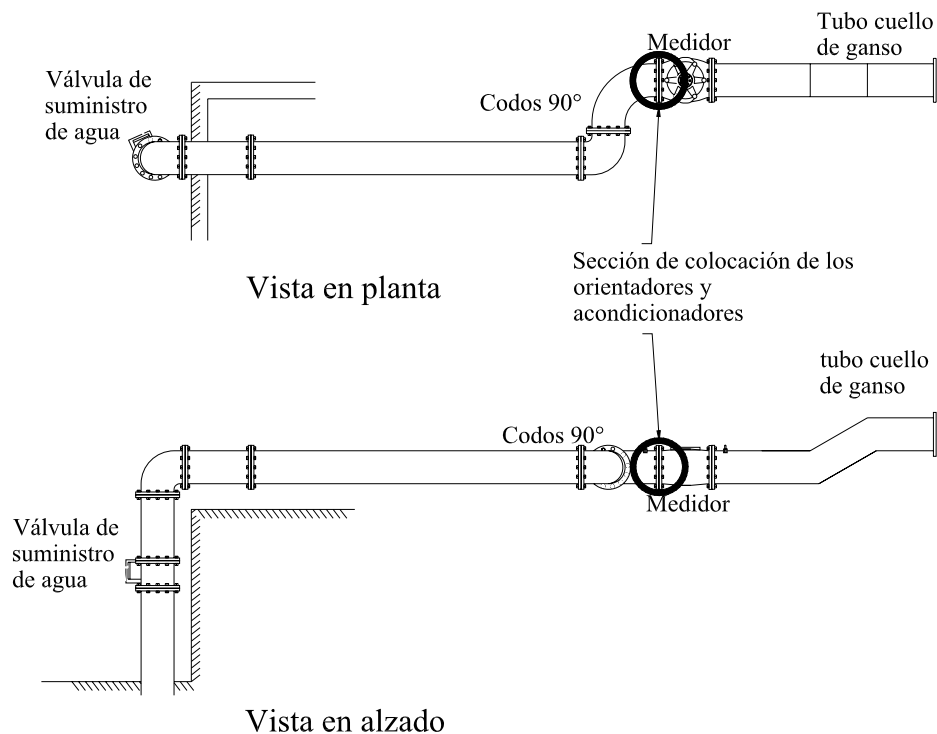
Esquema del tren de descarga; detalle planta y alzado.
